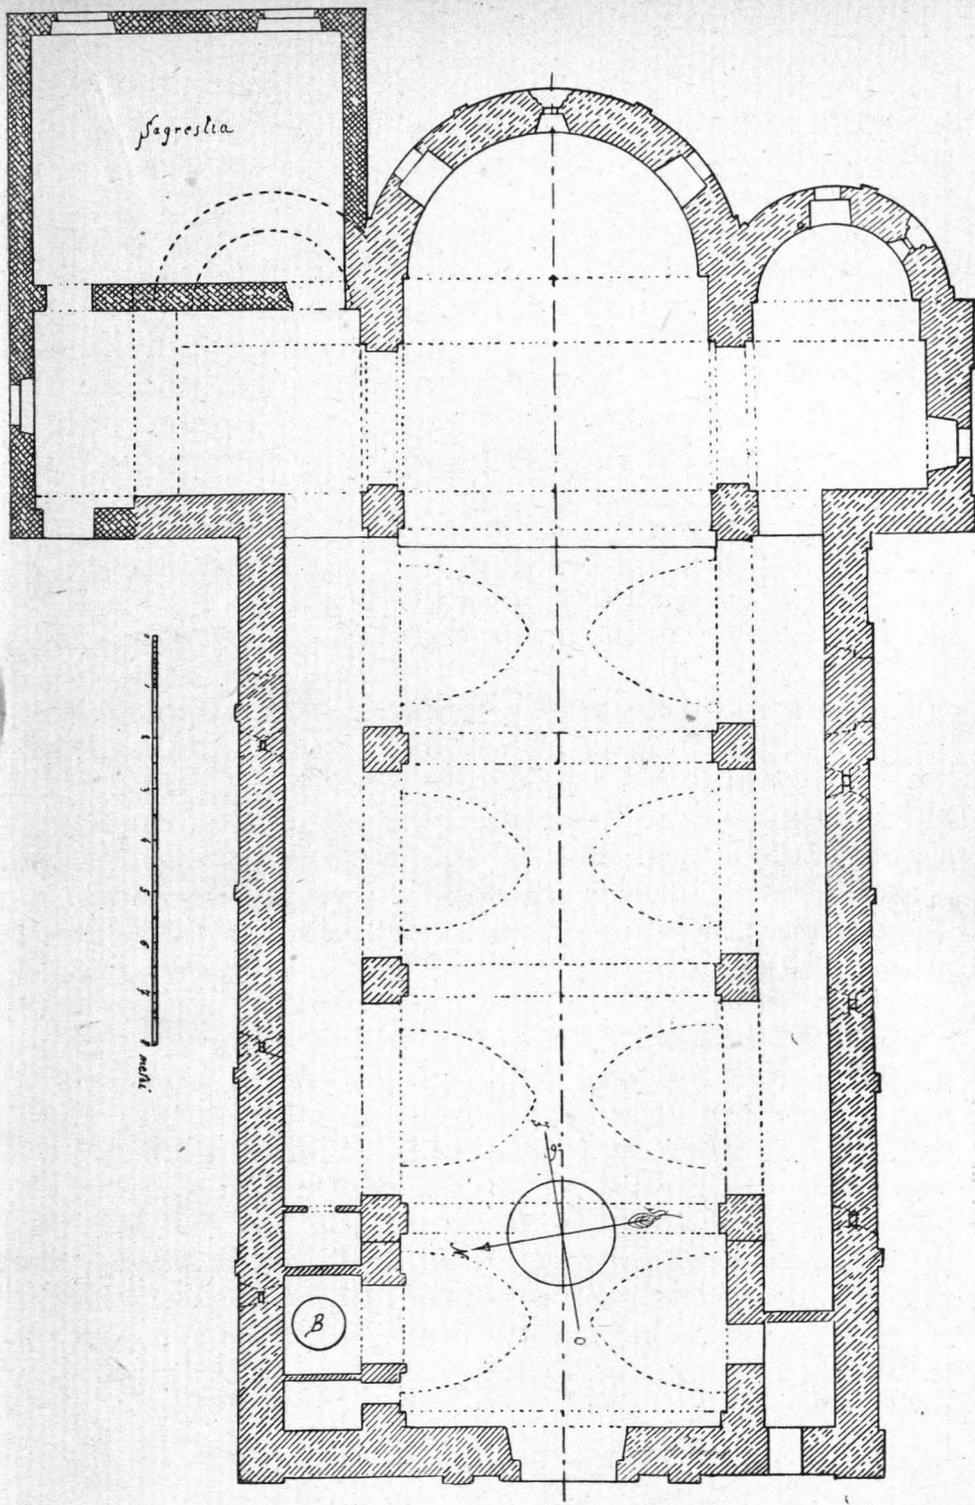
L'antica parrocchia di Brione. Pianta.
